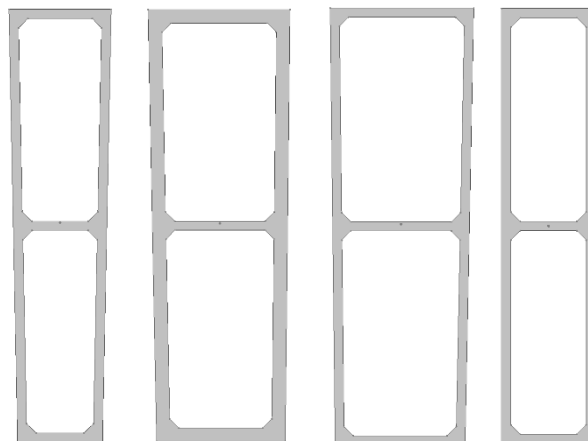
Geometria delle sezioni caratteristiche delle pile con armature longitudinali
